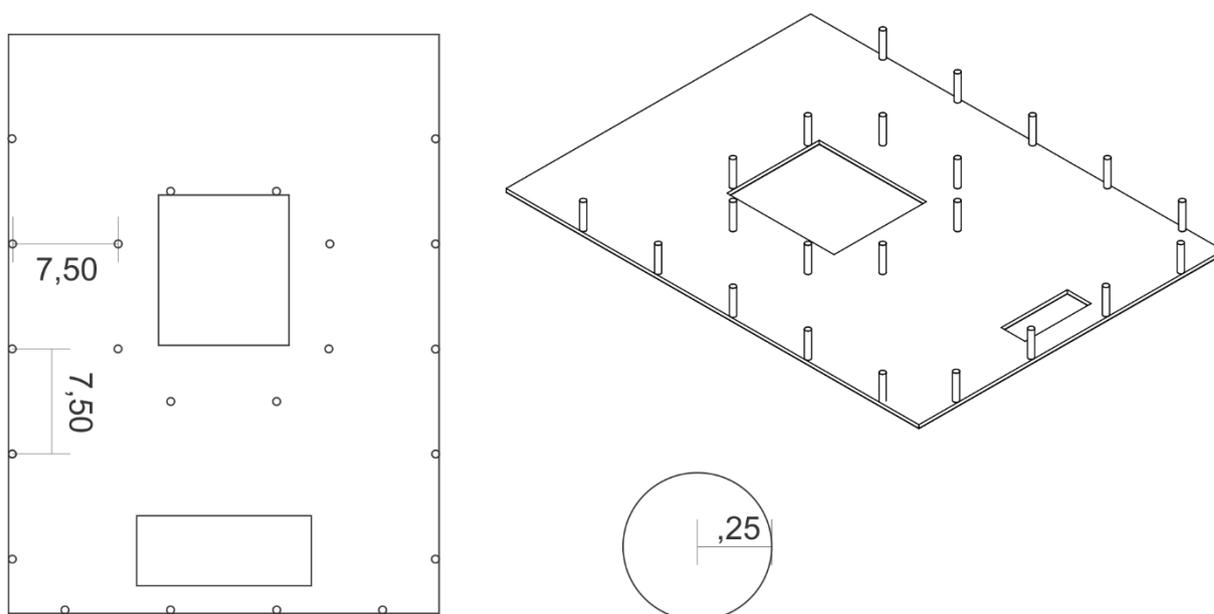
Detalhamento 03 – Pilar Metálico em V.
